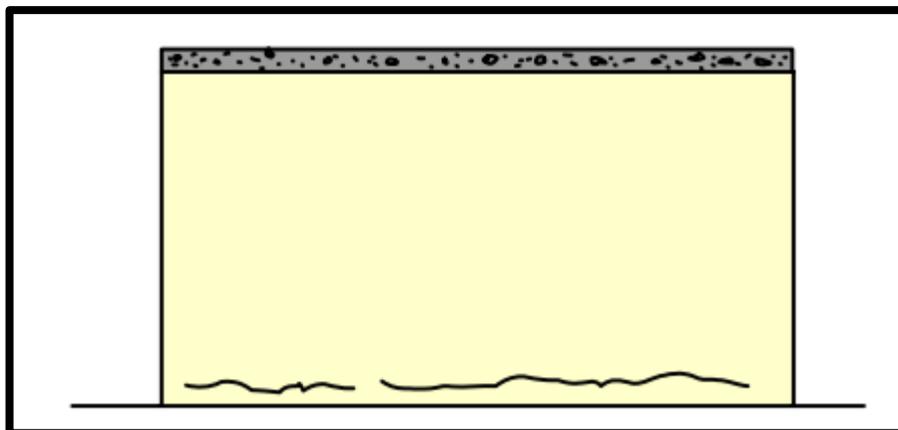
fissuras horizontais devido à expansão higroscópica.
